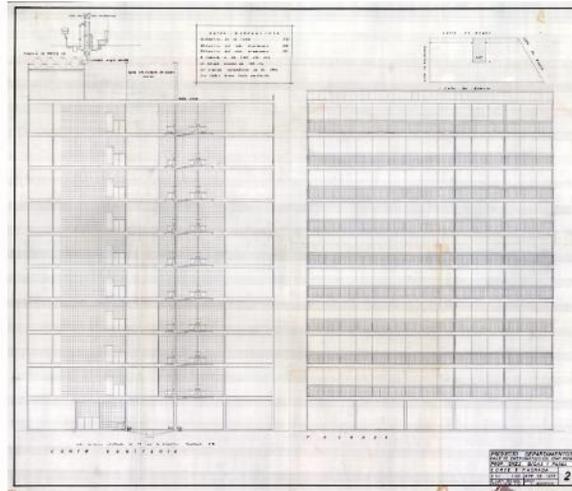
Plano del corte sanitario y la fachada del edificio ubicado en Emerson núm. 228, noviembre 1956
